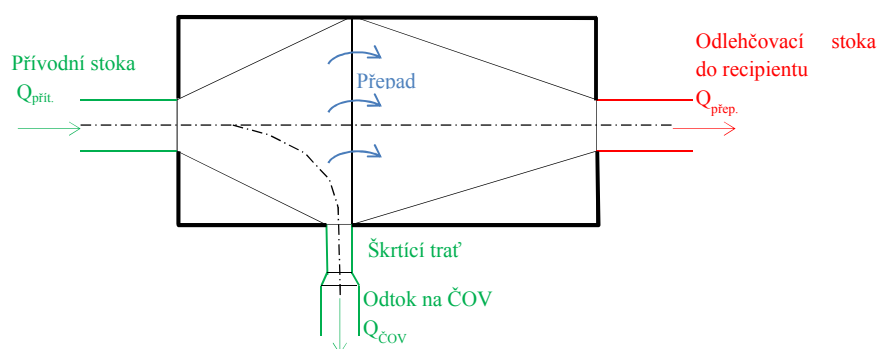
Odlehčovací komora s přepadem bočním oboustranným se šikmou hranou
